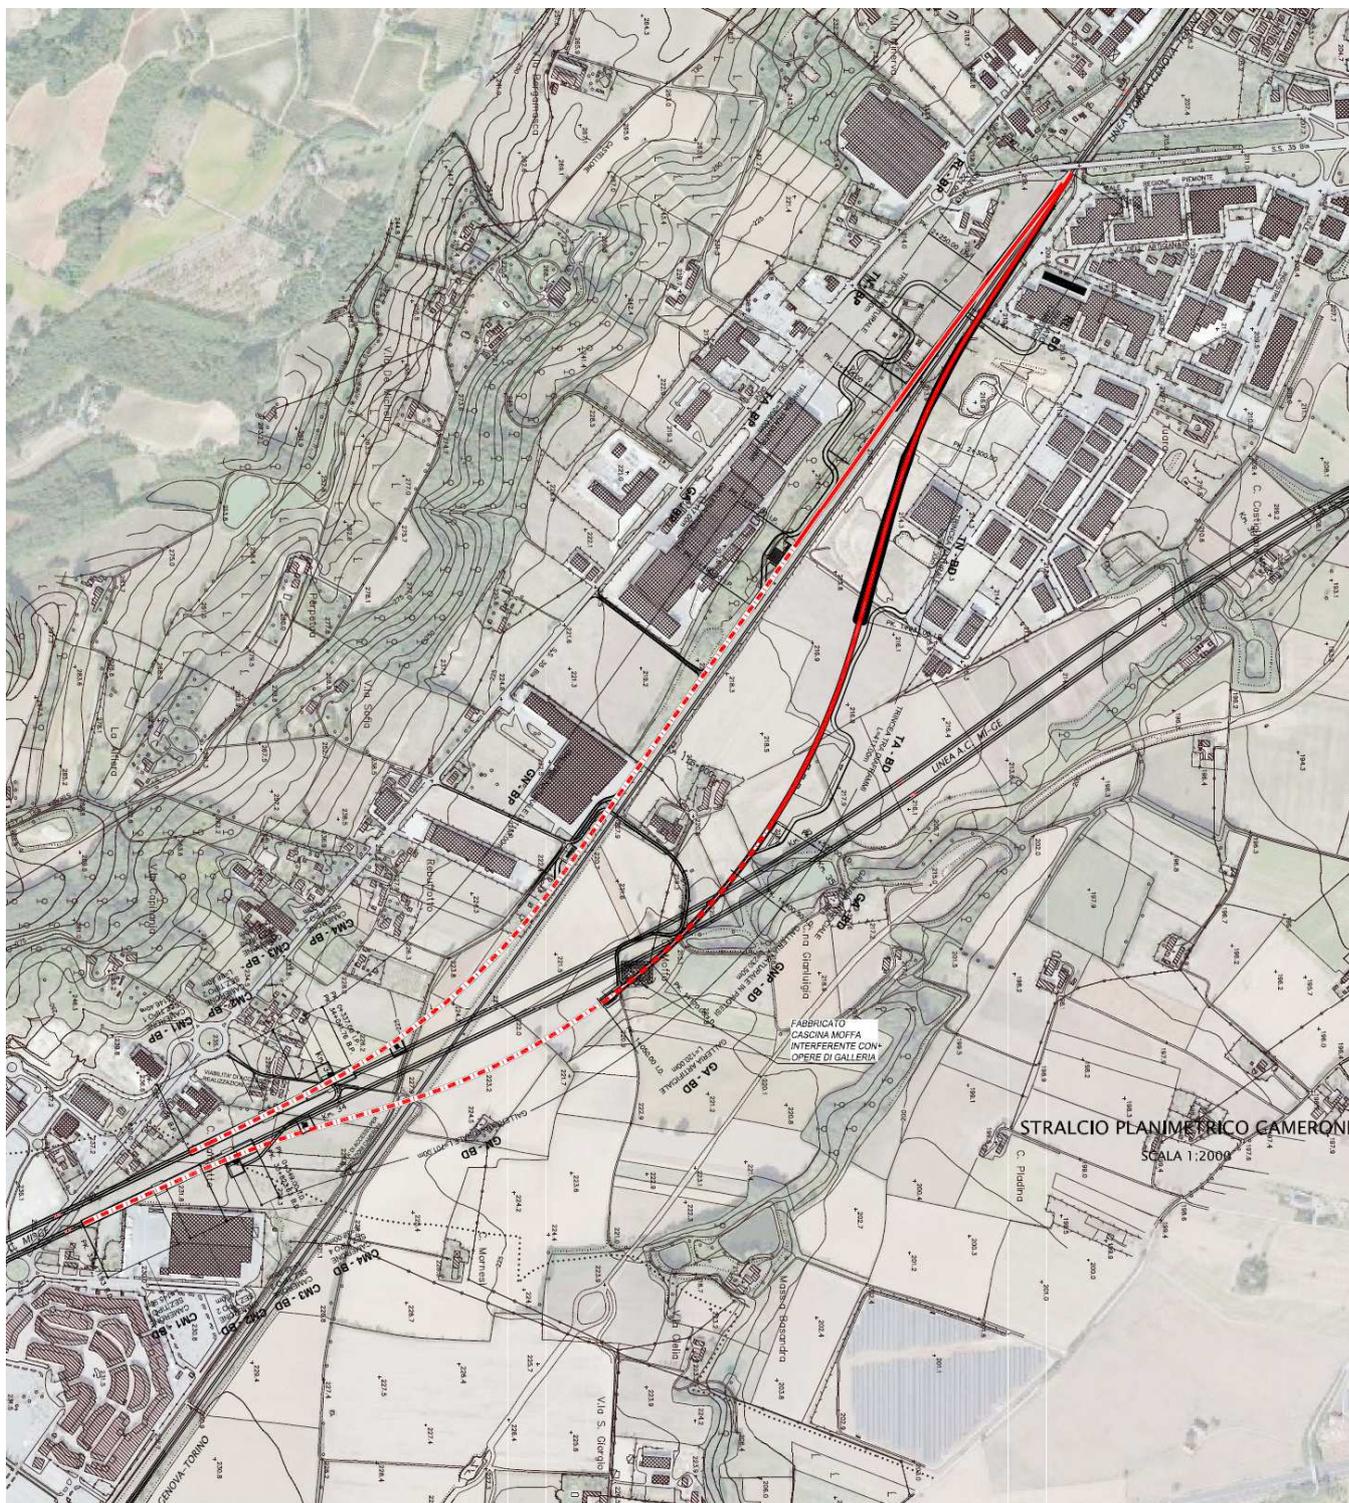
Stralcio planimetrico interconnessione 160 km/h
